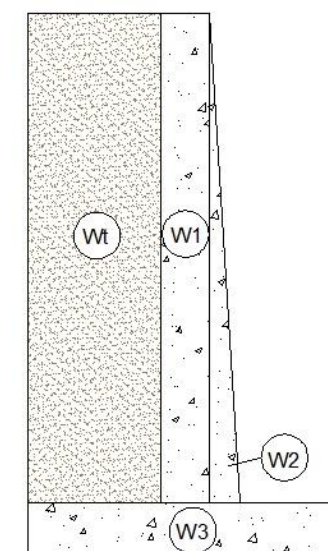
Figura XVI: SECCIÓN PROPUESTA PARA EL ESTRIBO
